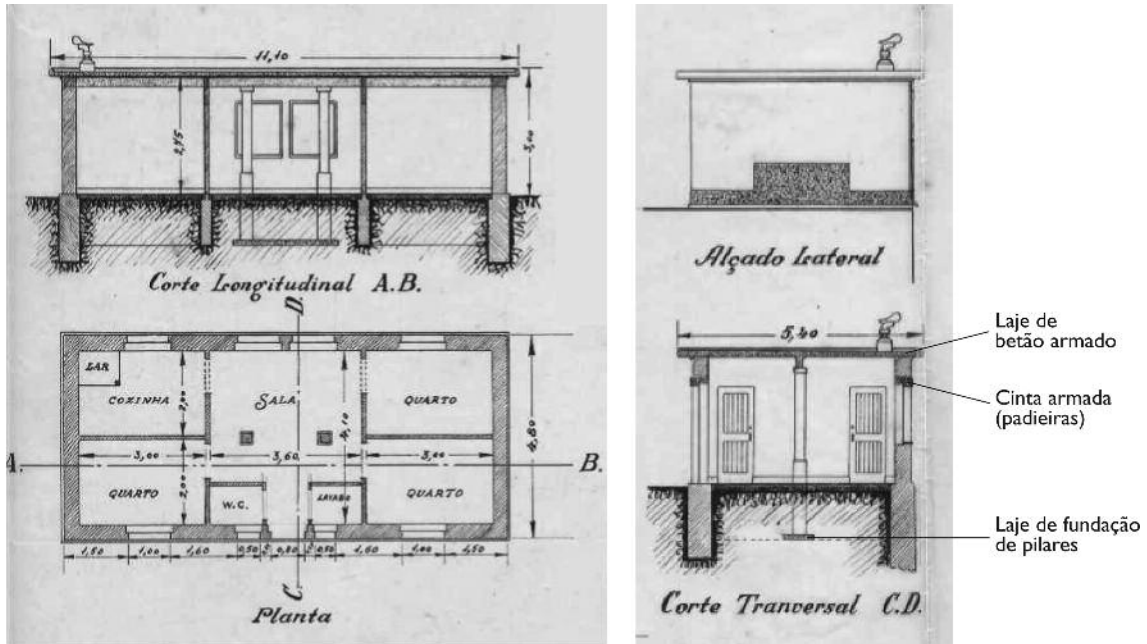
Reconstrução de casa do Pátio da Casa Amarela – projecto de 1937.
